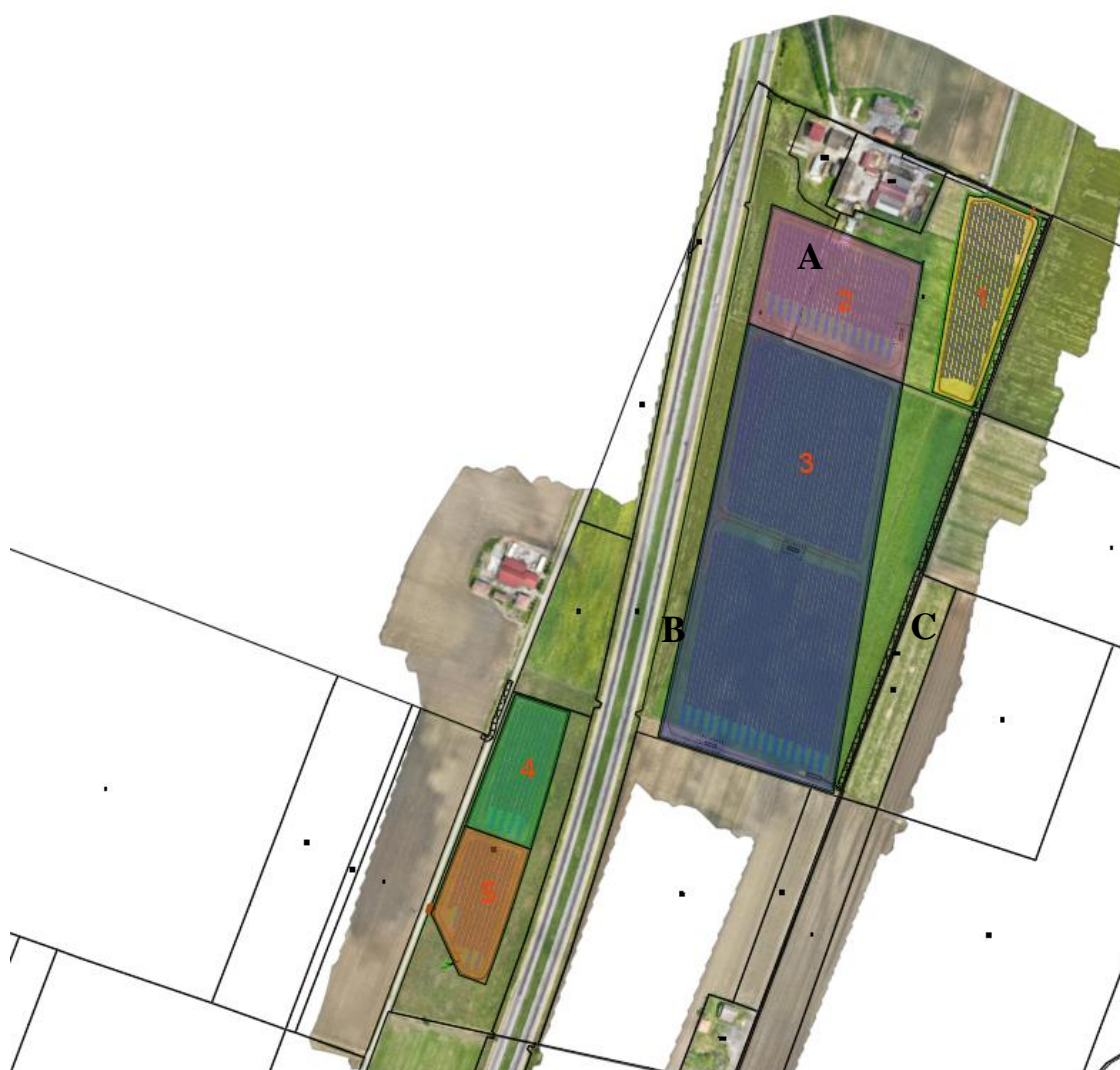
Planimetria rete di progetto – Sottobacini - Nord
